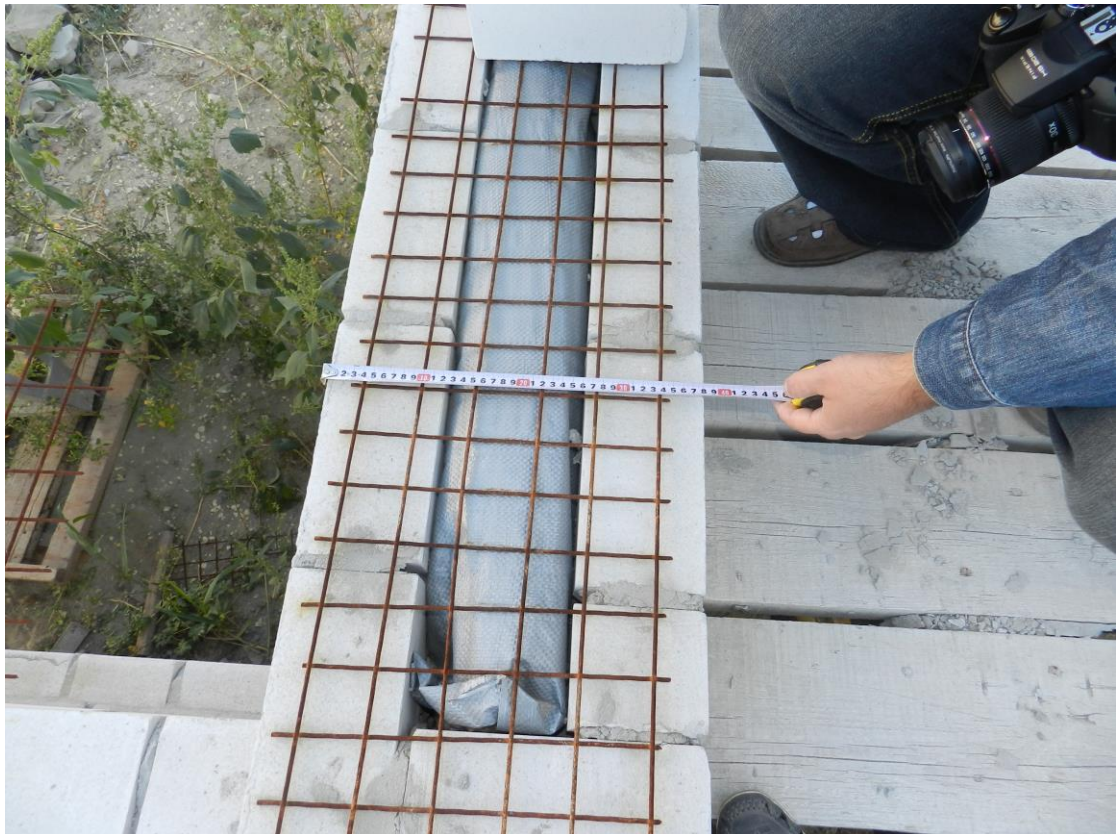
Фрагмент наружной стены в зоне утеплителя кирпичной кладки
